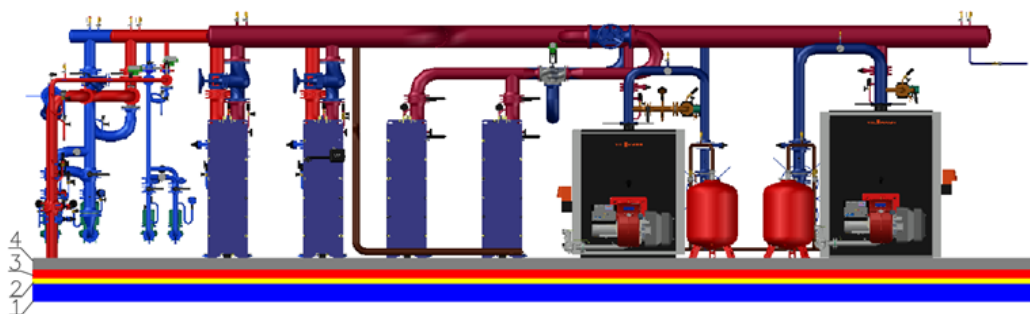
Схема установки инженерного оборудования крышной котельной на плите покрытия здания (без пола на упругом основании):
